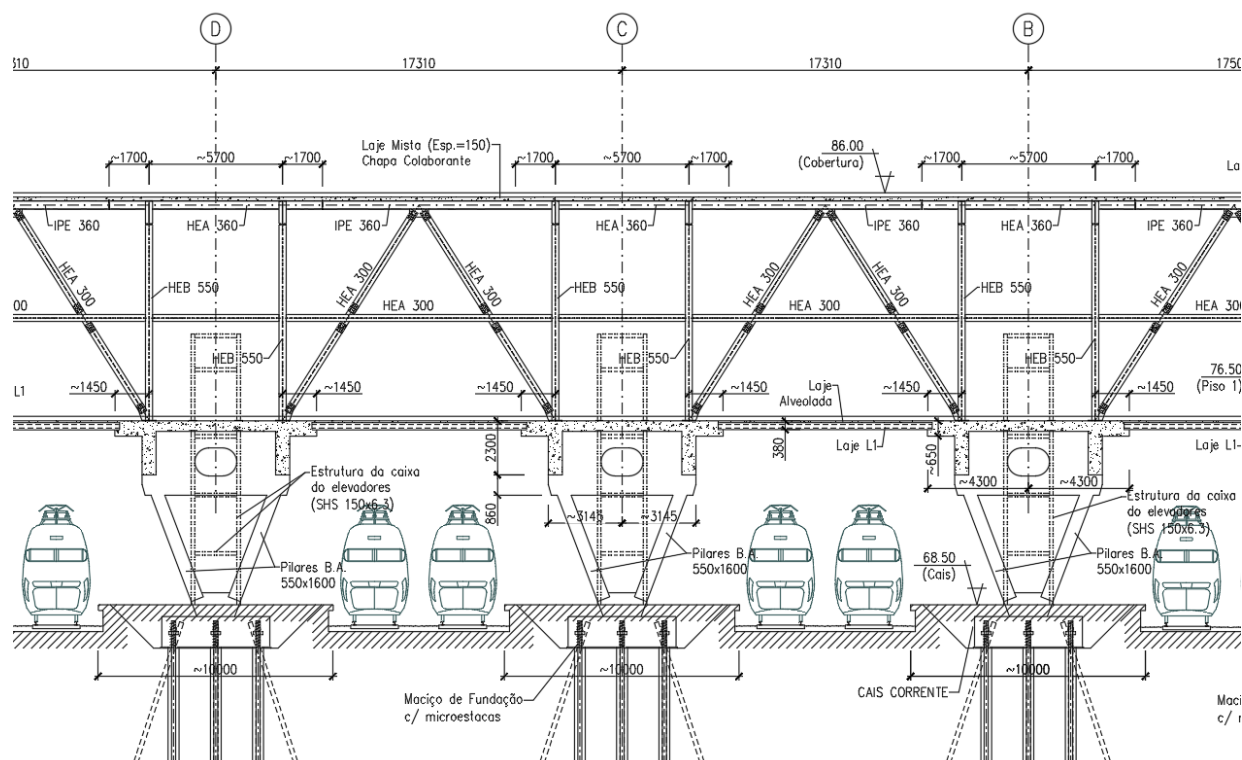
Edifício Ponte: Corte longitudinal cais corrente.
